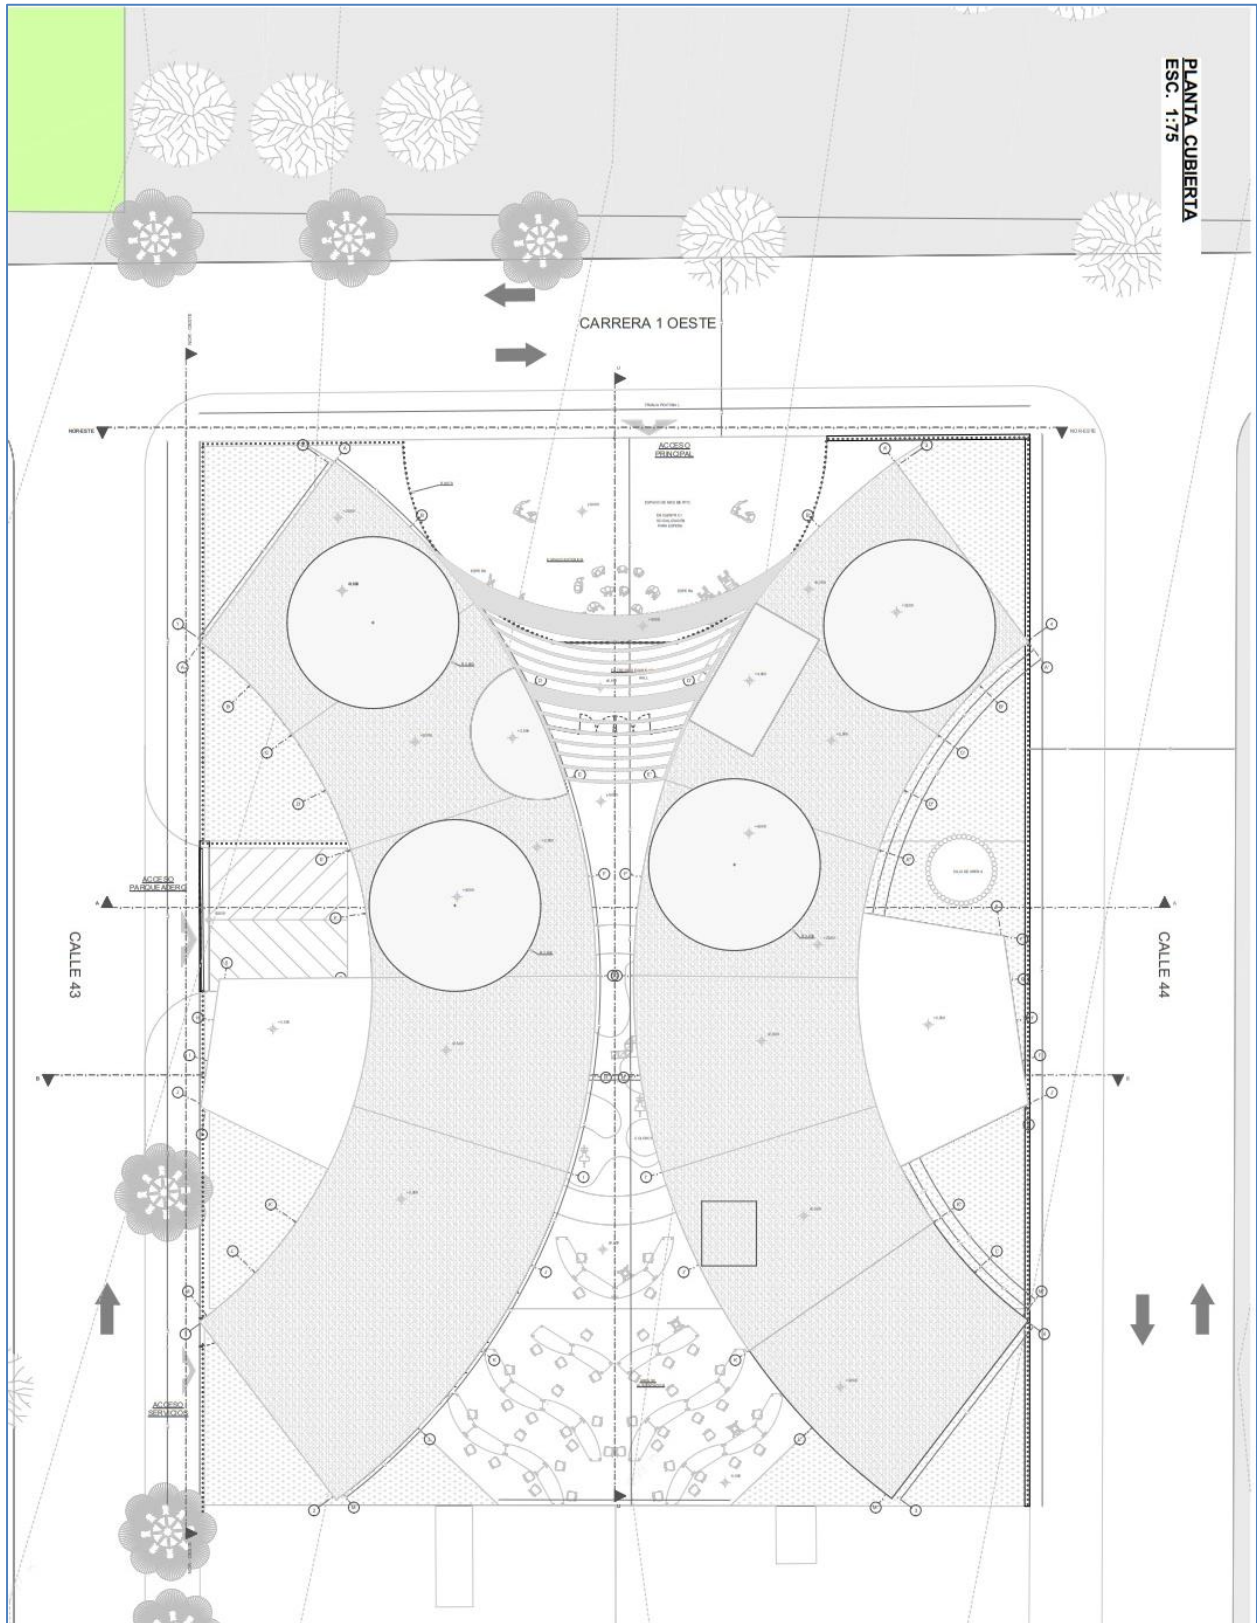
Memoria 06 planta arquitectónica general del proyecto CDI
